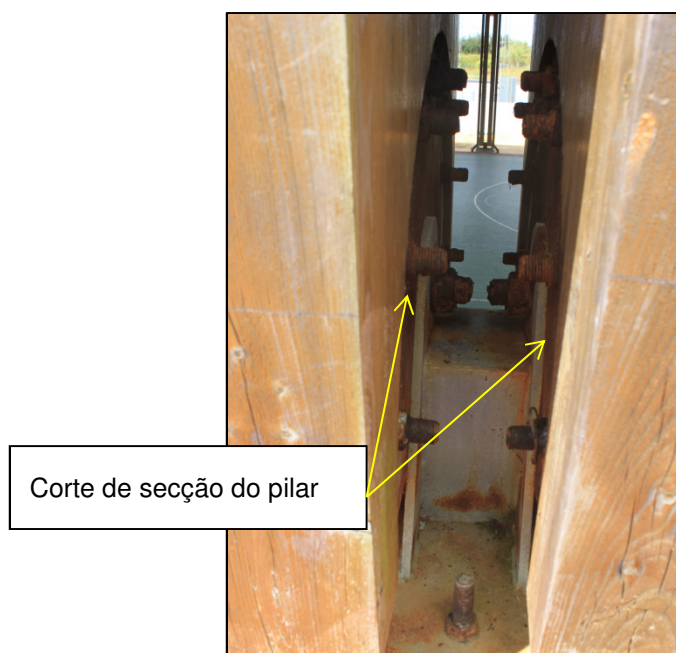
Corte em secção de pilar para permitir o encaixe nos apoios.
